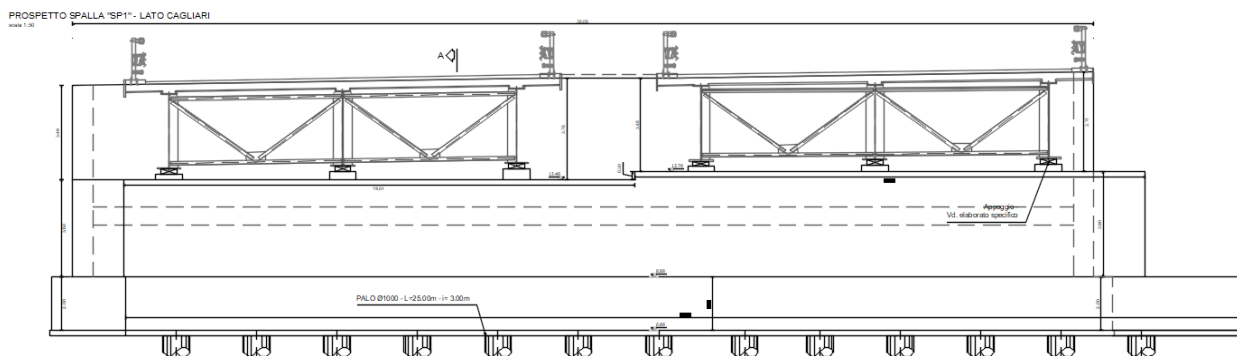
Prospetto spalla lato Cagliari
